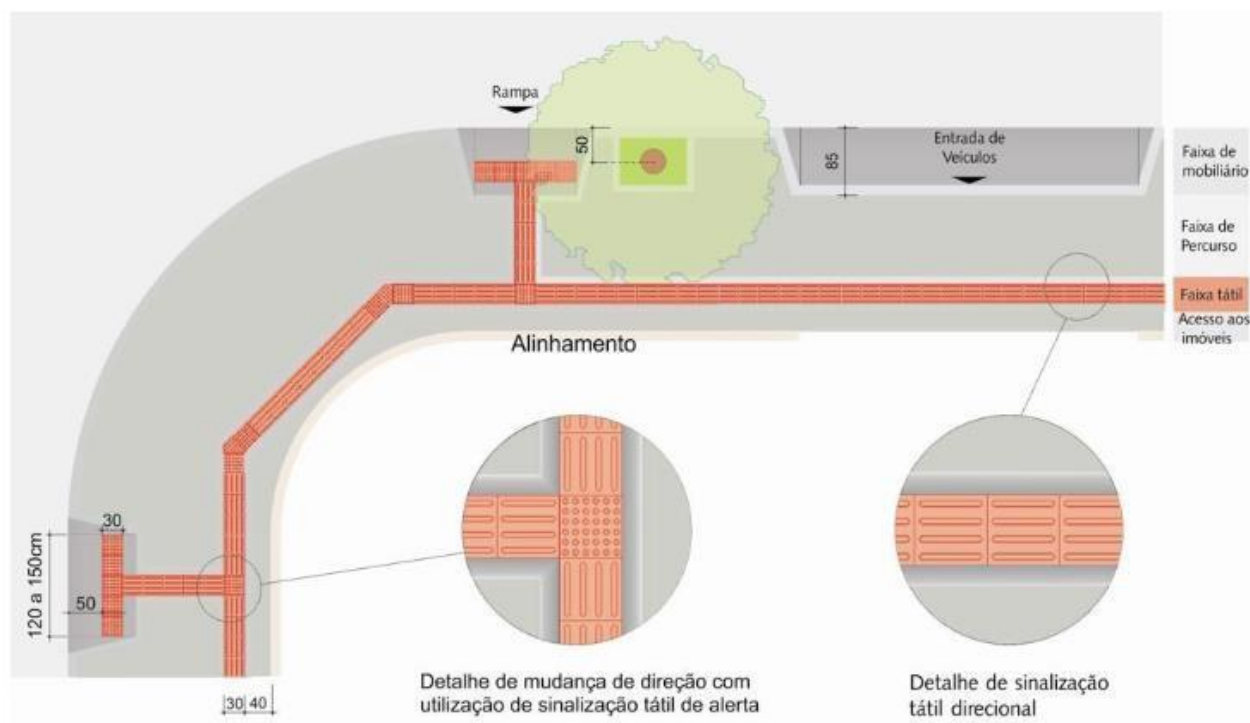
Esquema para aplicação de piso tátil em calçadas em concreto polido.
